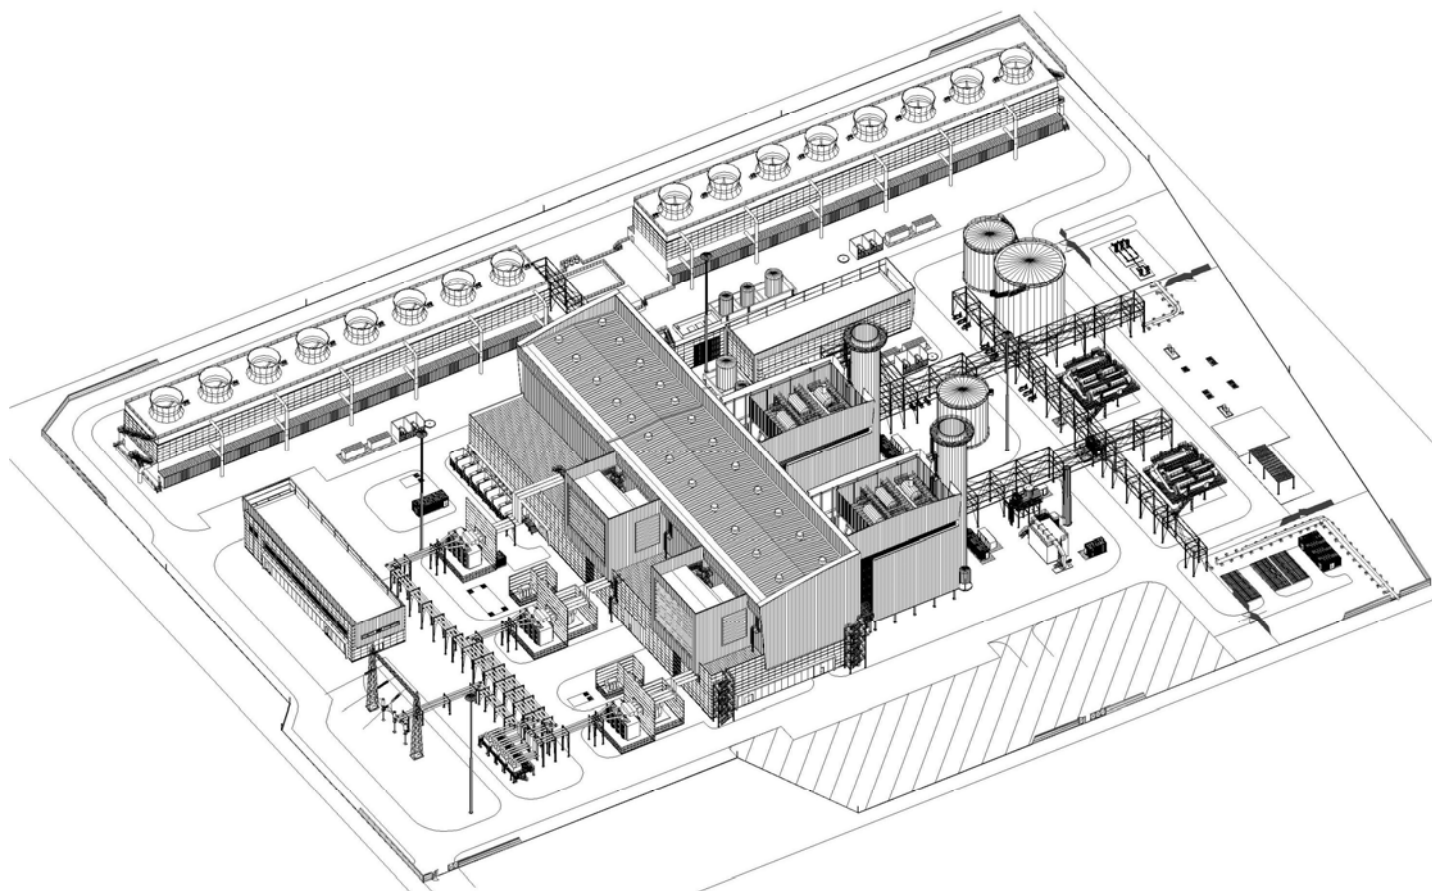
Fase B: Rimozione Tubazioni di Collegamento e Carpenteria
